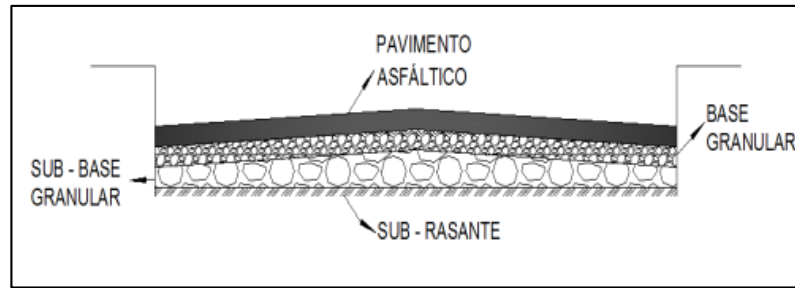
Sección Transversal Típica de un Pavimento Flexible.
